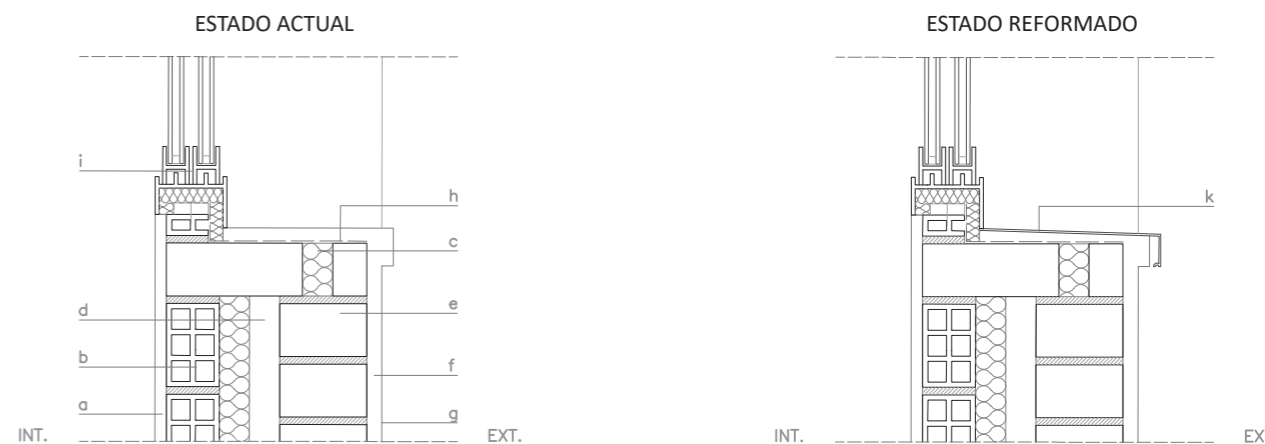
Detalle constructivo. Ventana tipo 1. Fachada principal. [Tabla 1]
